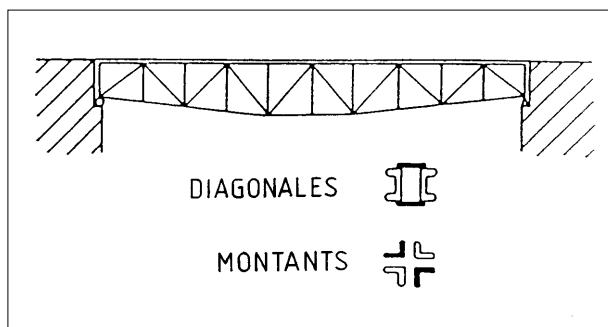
Pont métallique/poutres maîtresses à treillis. Éléments renforcés :
